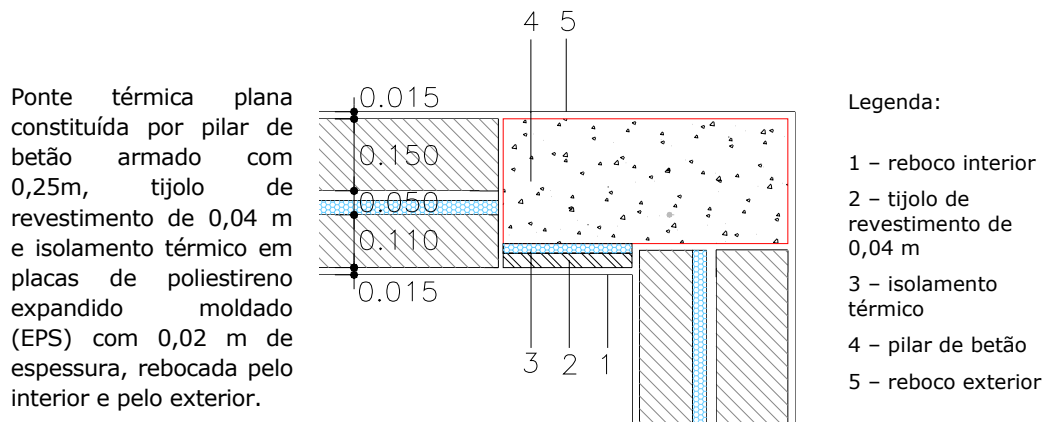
D.7– ponte térmica plana - Pilar de betão armado.
